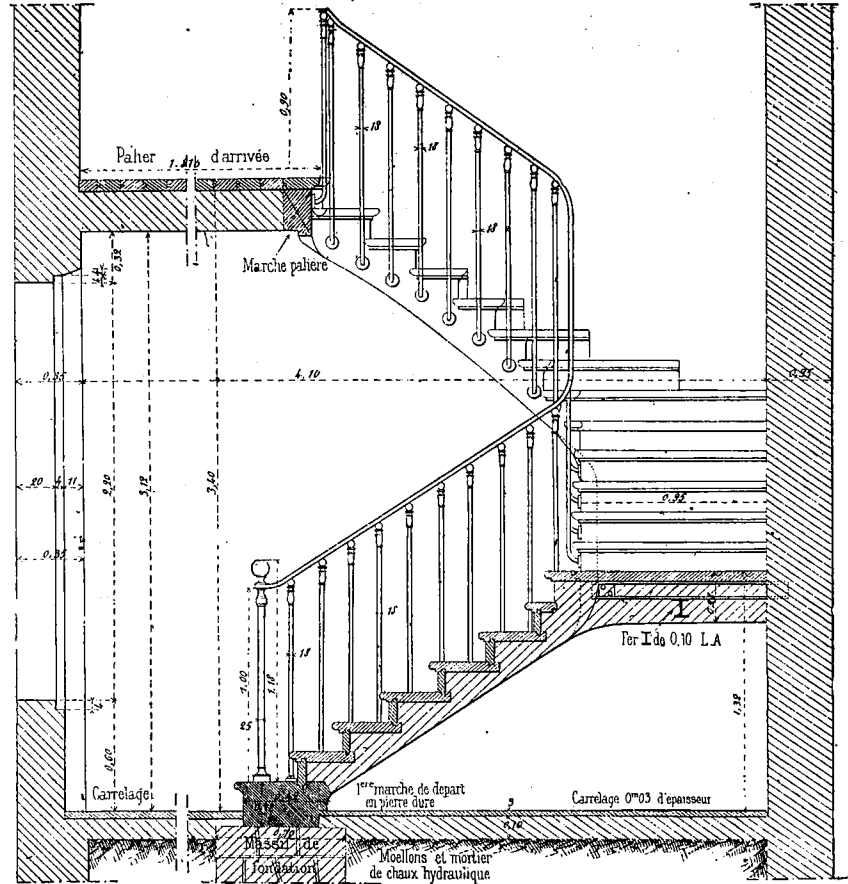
Coupe verticale suivant AB du plan (fig. 497).
